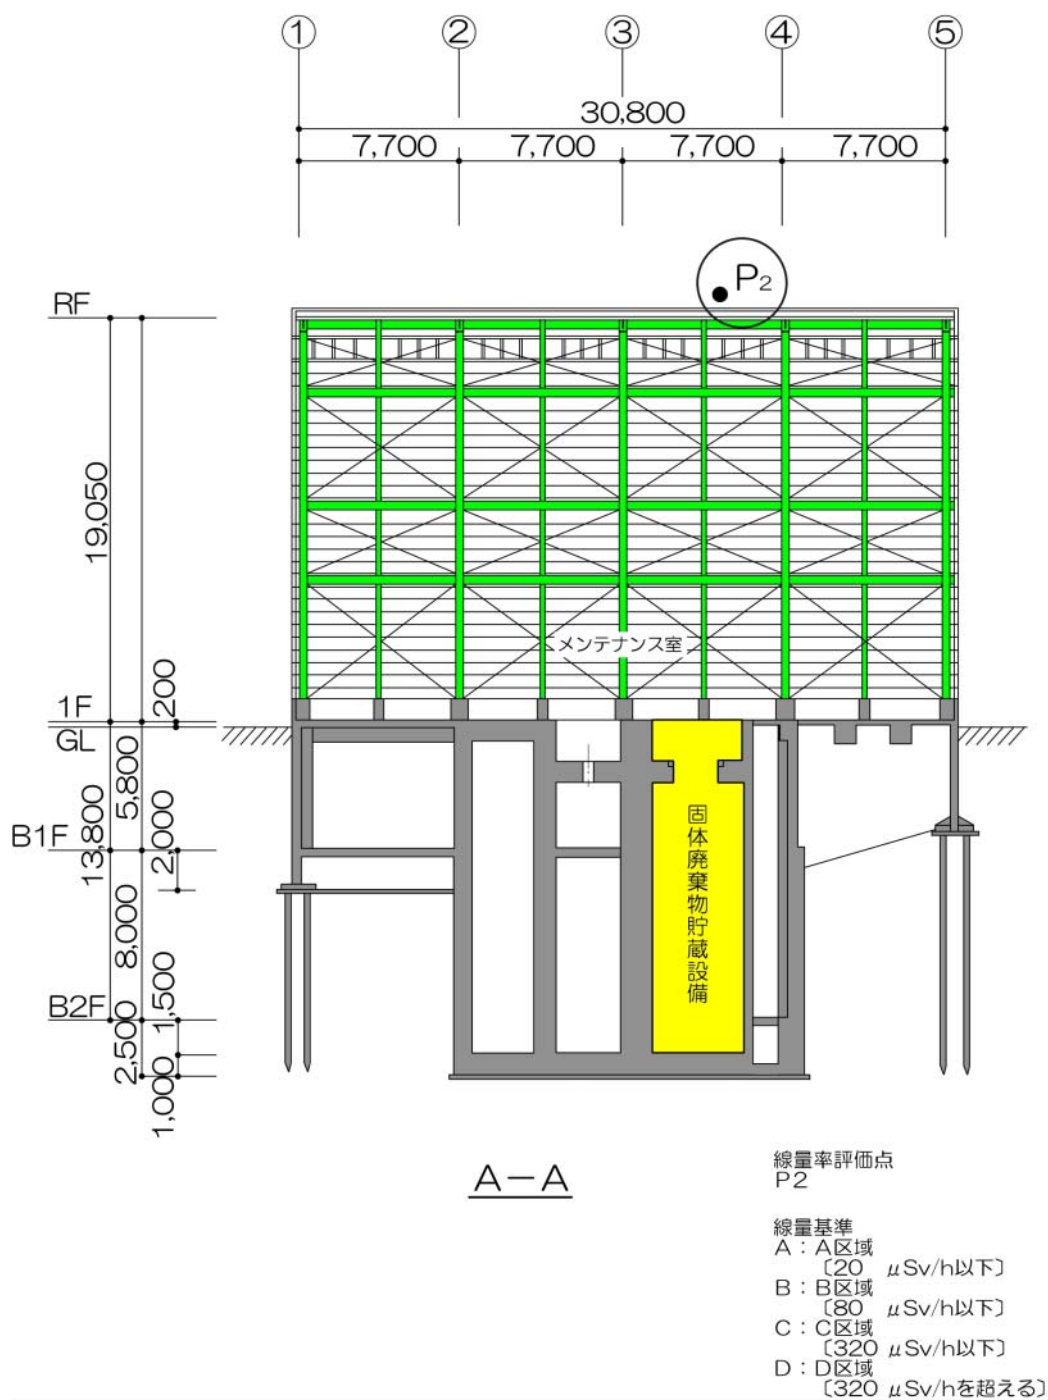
(2/2) メンテナンス建物の配置図 (断面図)
